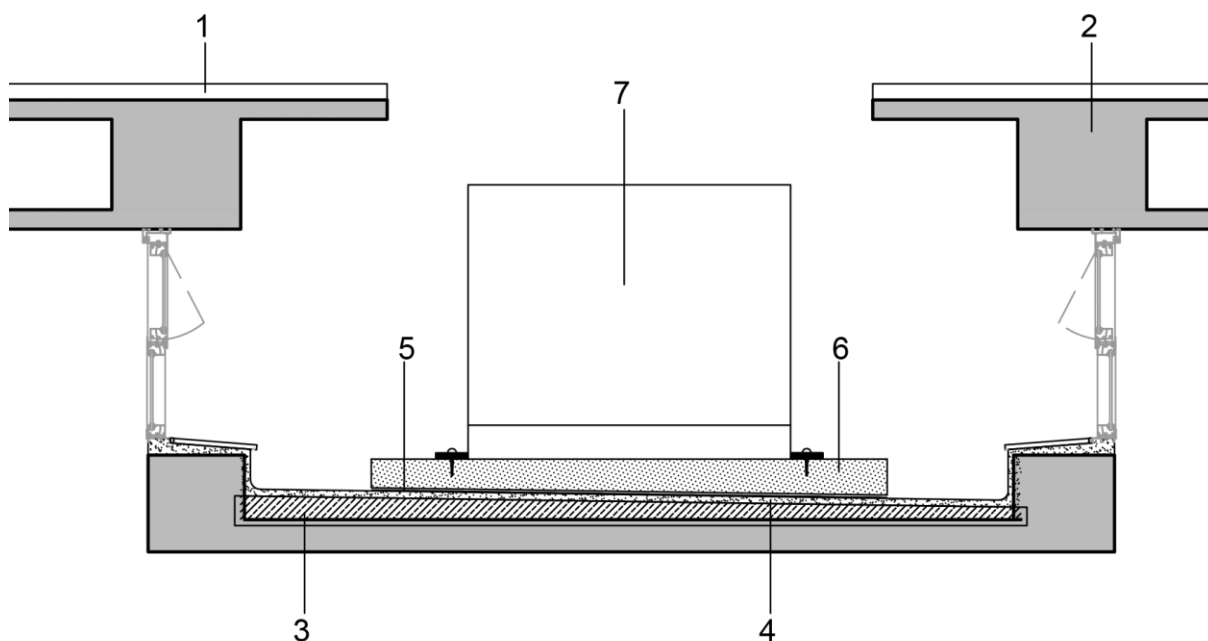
Laje rebaixada onde se concentra os equipamentos de apoio do edifício principal do IO (Fonte: SEF)
